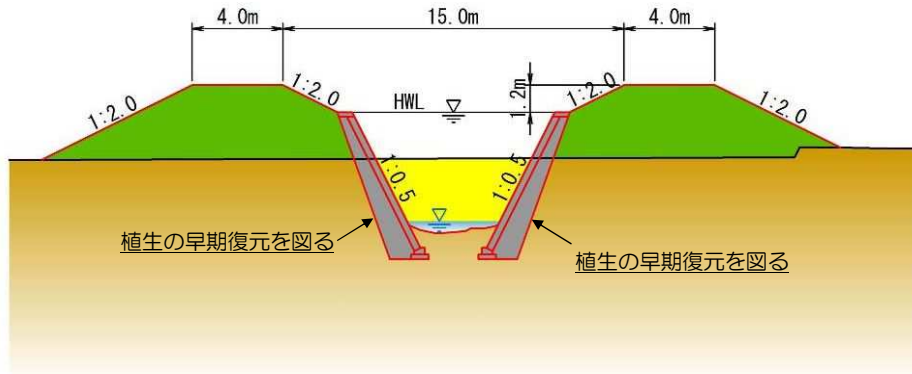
(4) 奥迫川縦断面図 (放水路)
